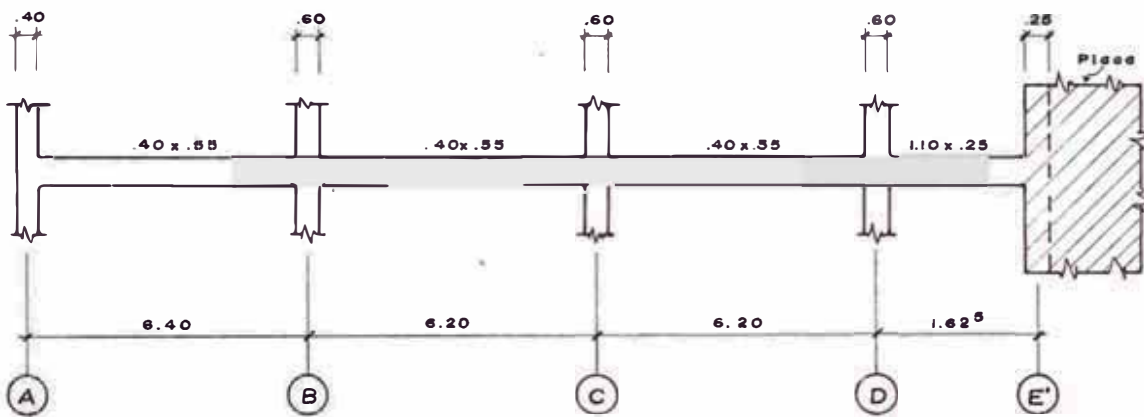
Esquema de Viga Pórtico 3 - Segundo Nivel
